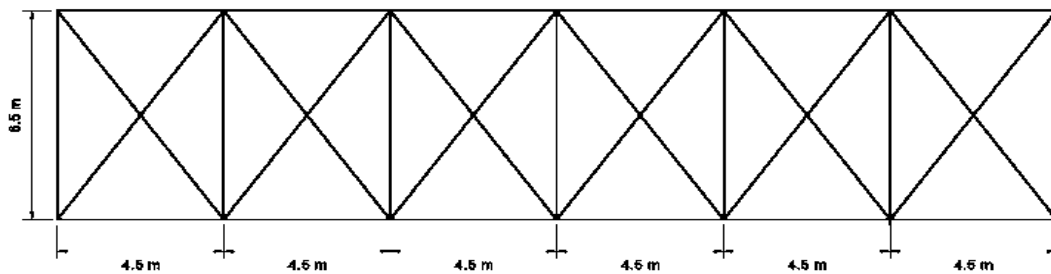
c Dimensiones de la nariz de lanzamiento en planta.
